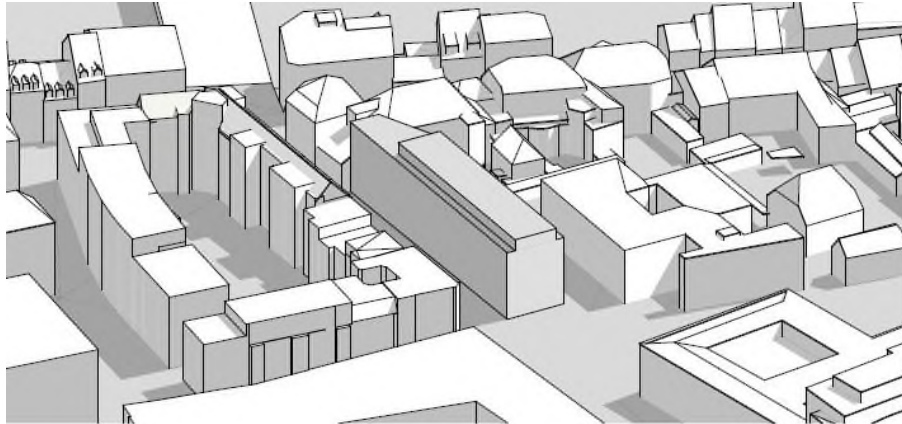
D-Modell, Baufeld Etappe 2- mit einzusetzendem Neubau Kopfbau BRCCH in Situation mögliches Gebäudevolumen Hauptbau Schanzenstrasse 7-13, Zone W6 (Einsatz Modellgrundlage)
